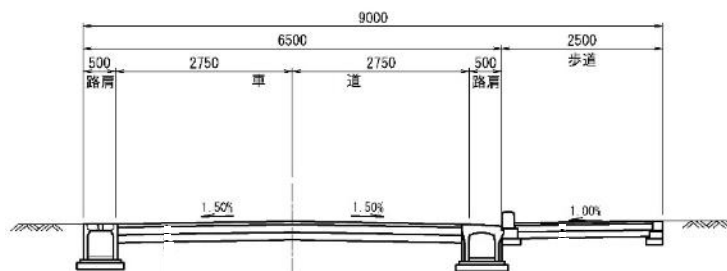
(4) 標準断面図 (区画道路 幅員 9.0m)
